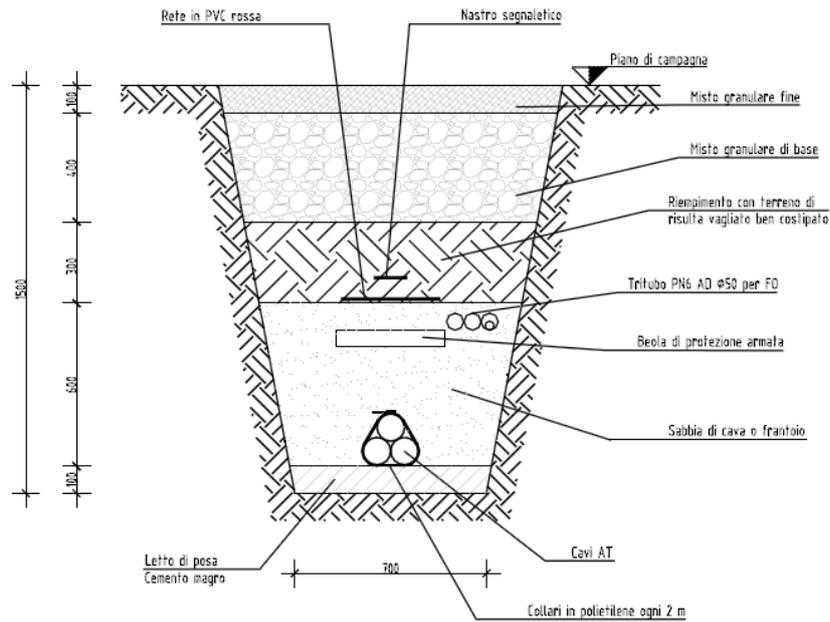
Sezione tipica di posa della linea in cavo su strade sterrate (1 terna)
